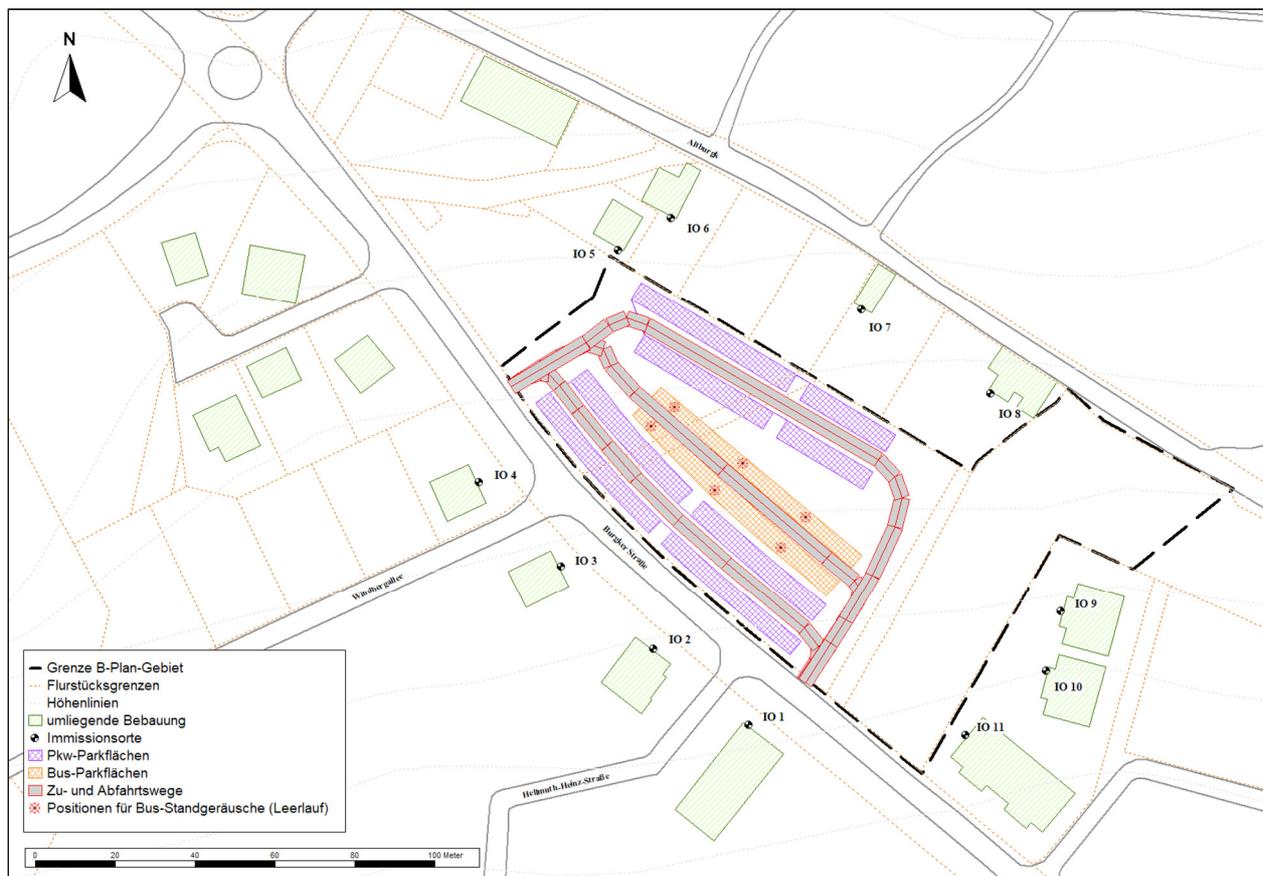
Übersichtslageplan des Rechenmodells (Ausschnitt)
